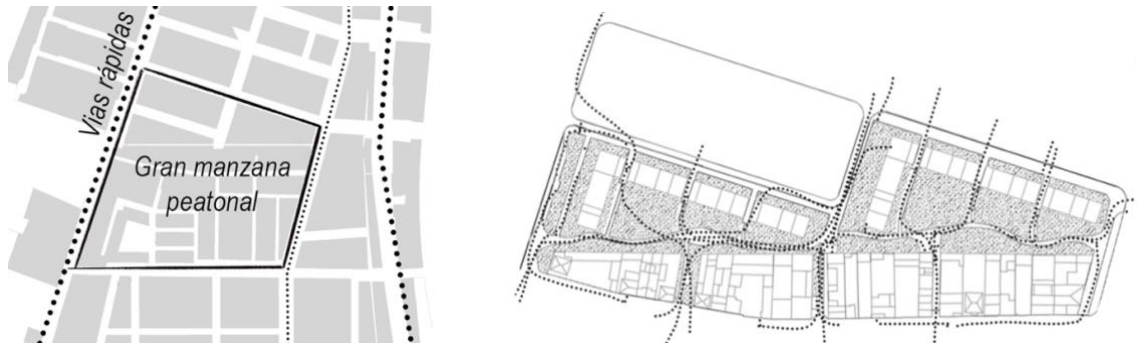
A la izquierda, planta del ámbito. A la derecha, planta del nuevo Jardín urbano de Las Villas.
